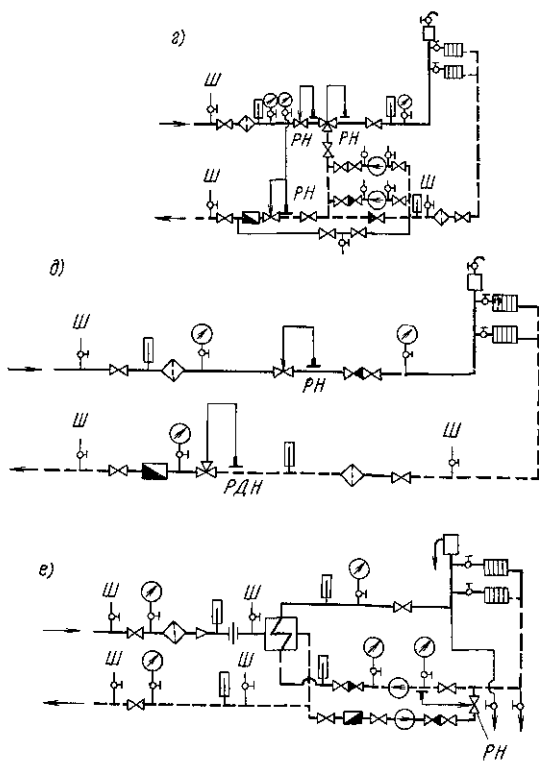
Схемы присоединения систем водяного отопления к тепловым сетям
